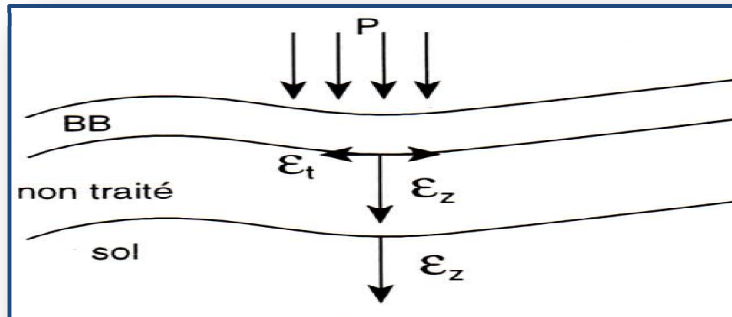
schémas de fonctionnement d'une structure de chaussée
